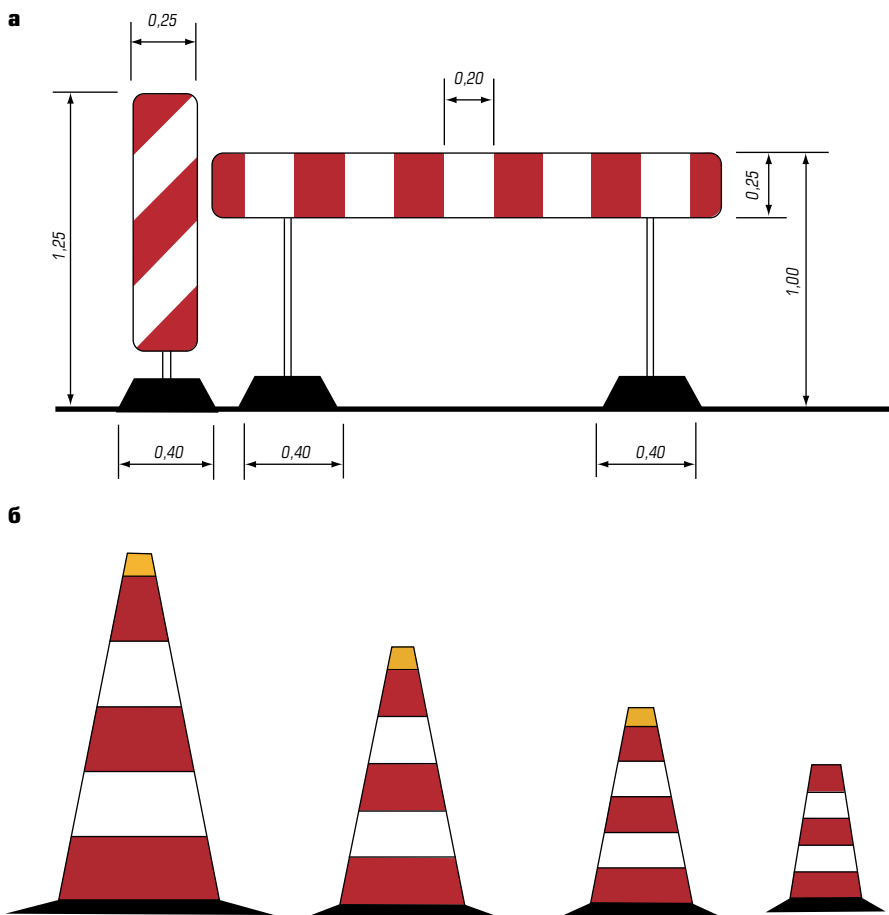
Заградительные устройства по нормам Германии: а — пластины и барьеры; б — направляющие конусы
